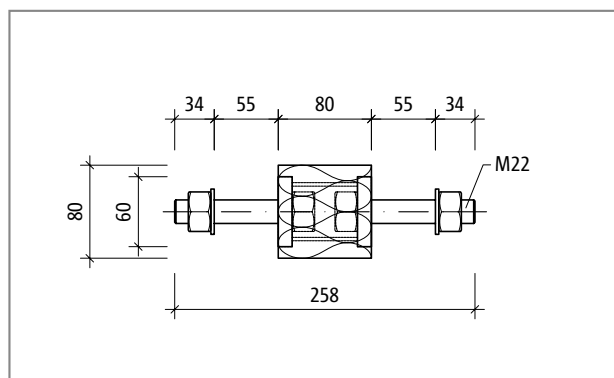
Schöck Isokorb® T tipo S-V-D22: sezione dell'elemento
